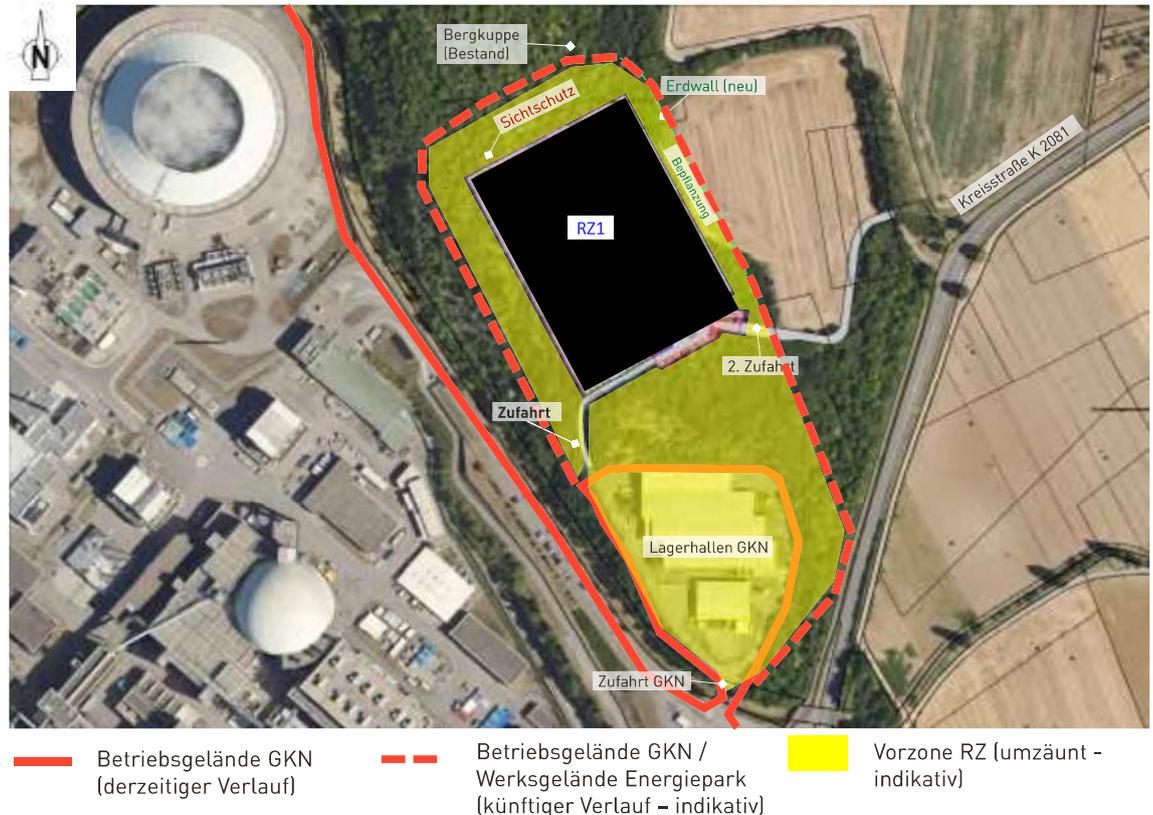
Lageplan mit Anordnung des Pilot-Rechenzentrums am Steinbruchrand (Variante V5-1 bzw. gewählter Standort) mit möglicher Anbindung an Betriebs-/Werksgeländes des GKN; [REDACTED] aus Vertraulichkeitsgründen geschwärzt
